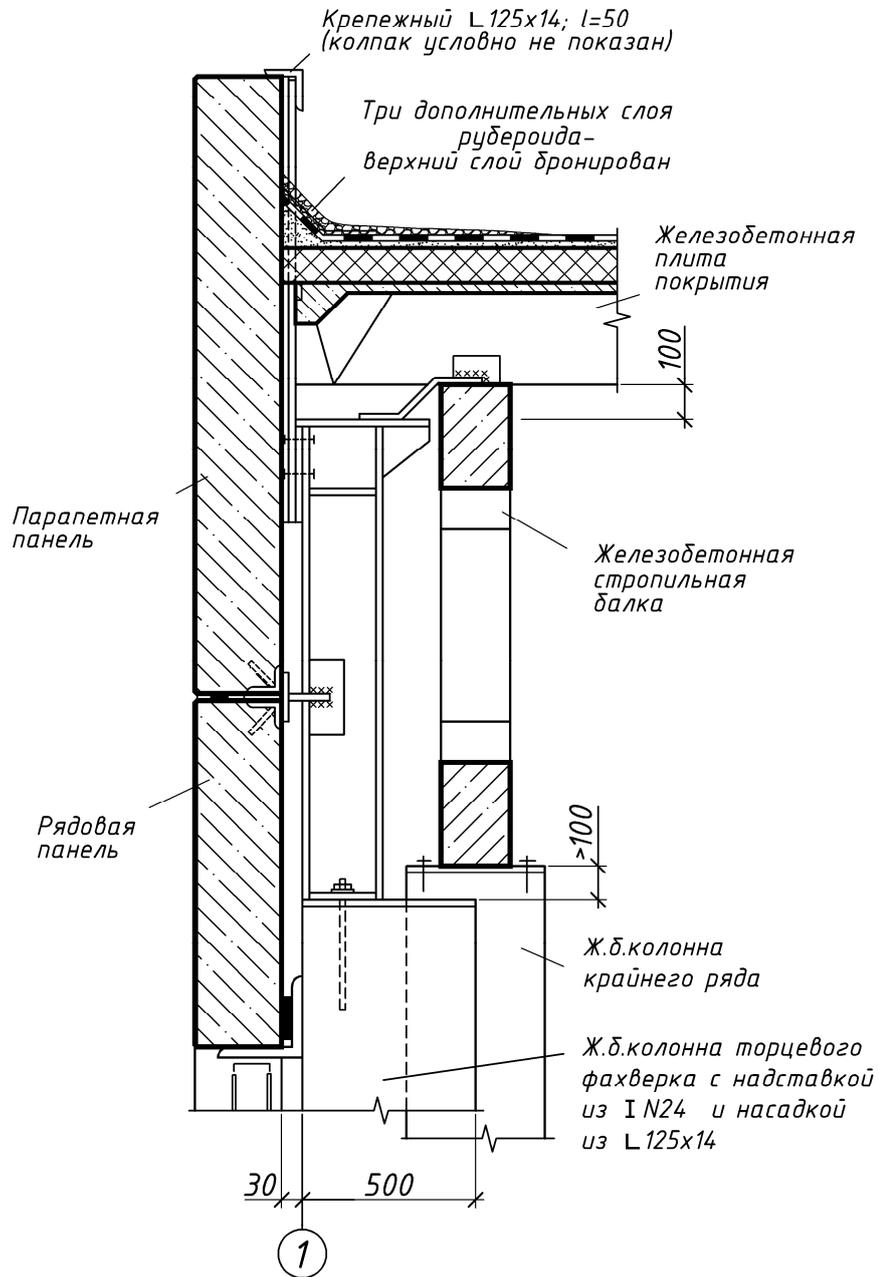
Узел опирания стропильной конструкции на колонну крайнего ряда
